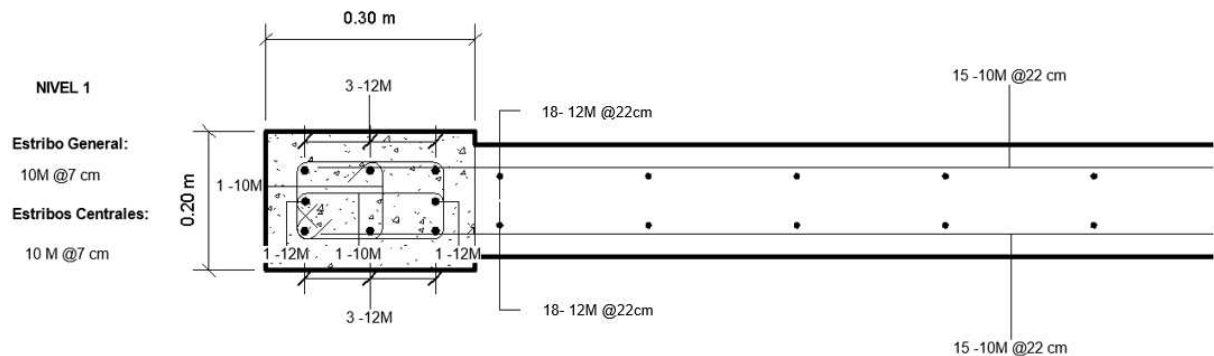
Secciones y armado de refuerzo cuando si se requiere elemento de borde para el sistema de 3 pisos
